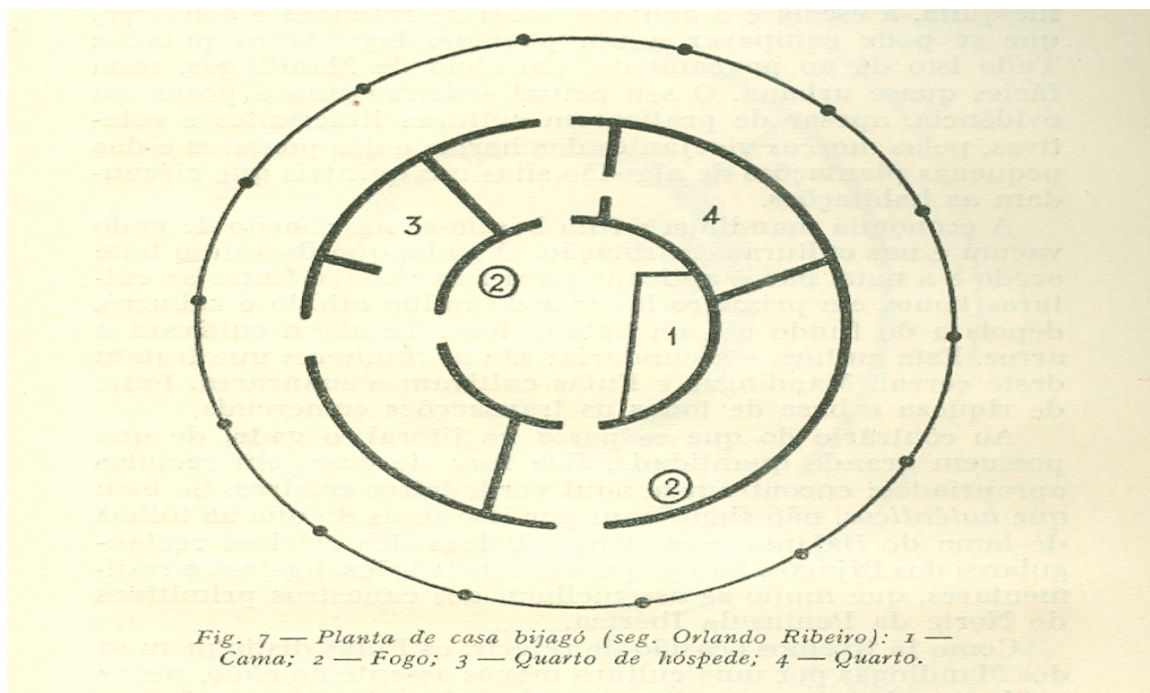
Planta baixa de uma habitação tradicional do povo Bijagô da Guiné-Bissau
